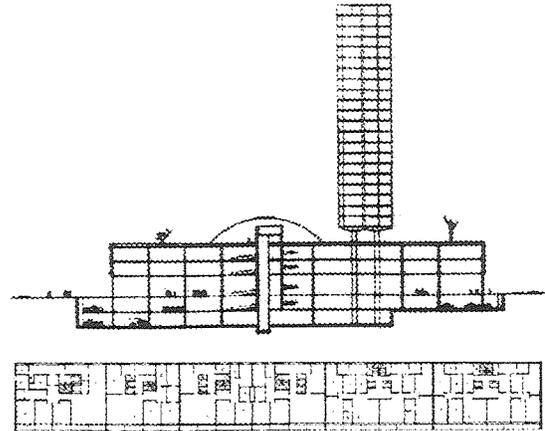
Conjunto Nacional, David Libeskind, São Paulo. Corte e planta residencial - originais.
